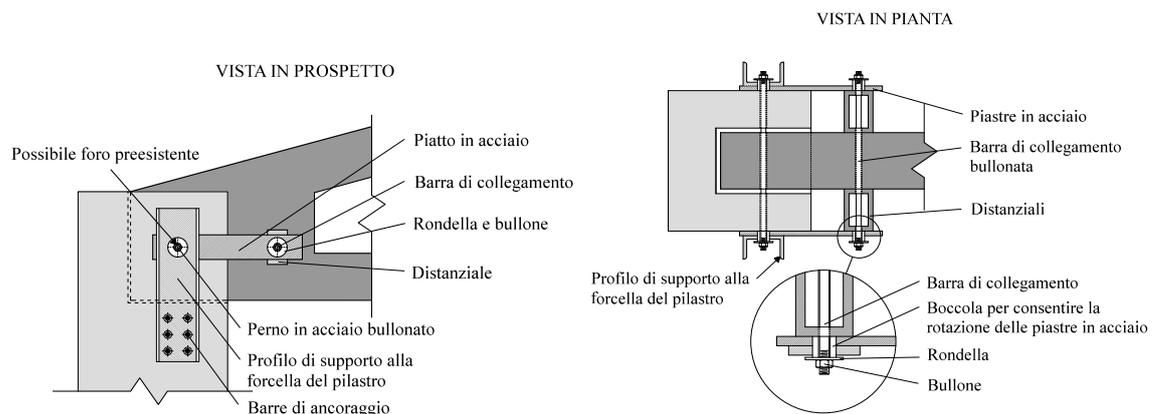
Intervento su connessione trave-pilastro mediante perni e piastre in acciaio
